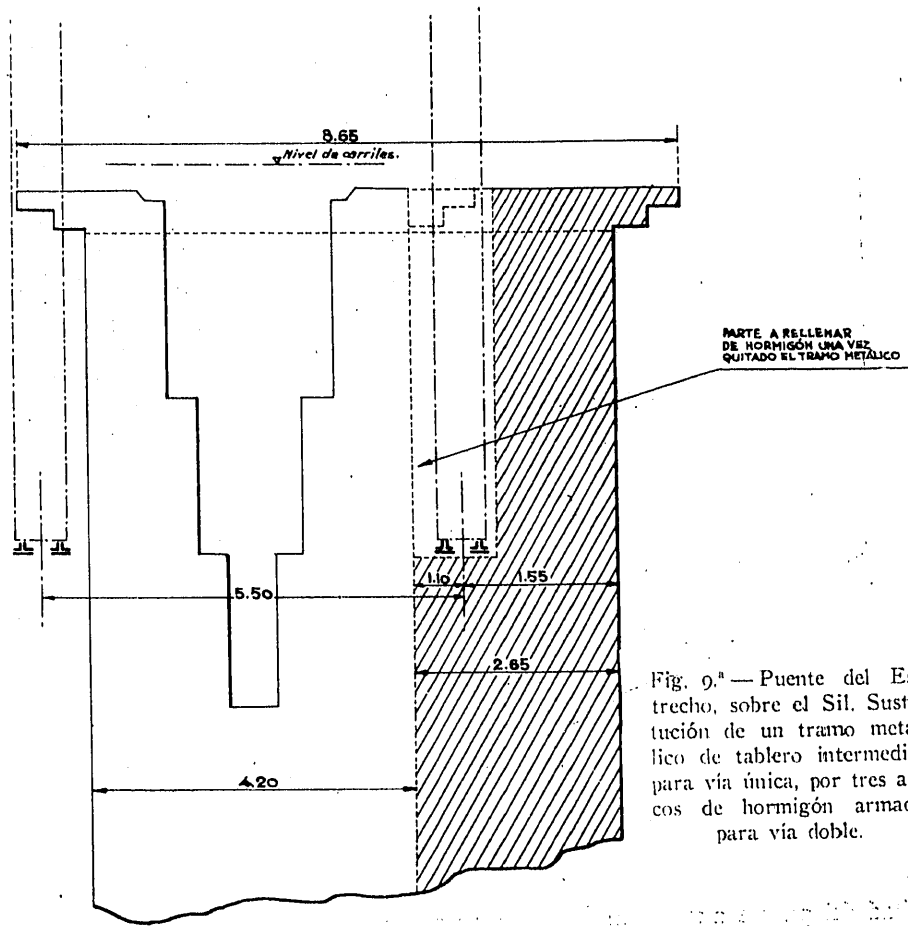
^a — Puente del Estrecho, sobre el Sil. Sustitución de un tramo metálico de tablero intermedio, para vía única, por tres arcos de hormigón armado para vía doble.
